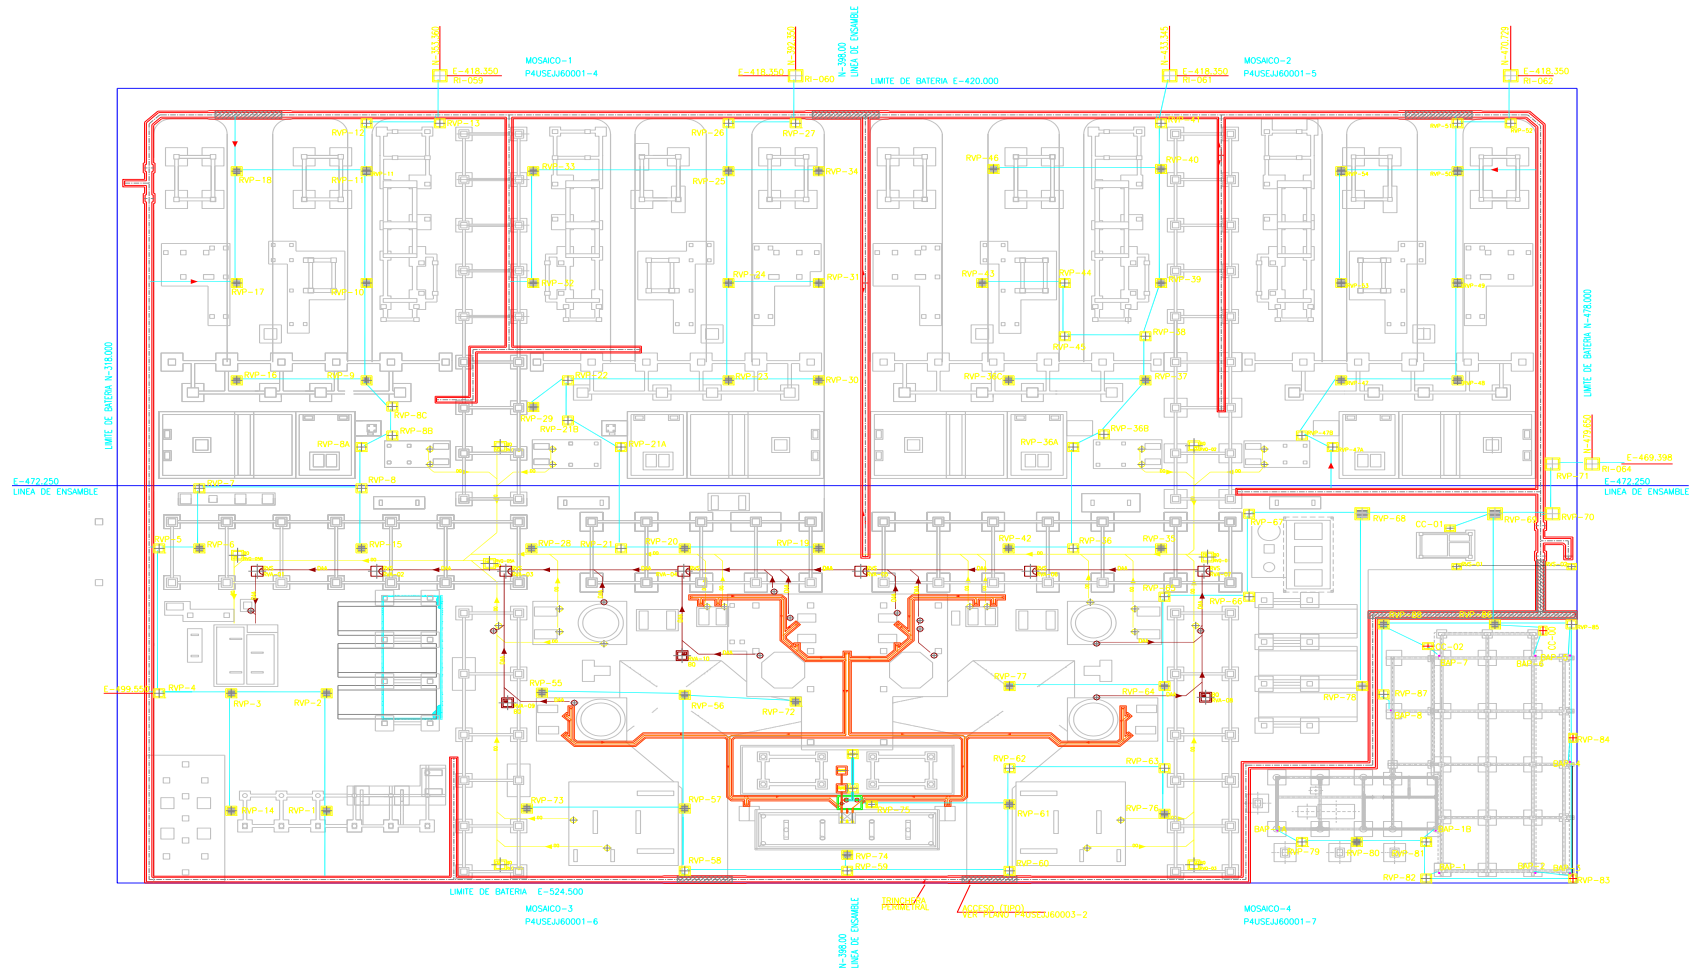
Plano general del sistema de drenajes de la unidad.
